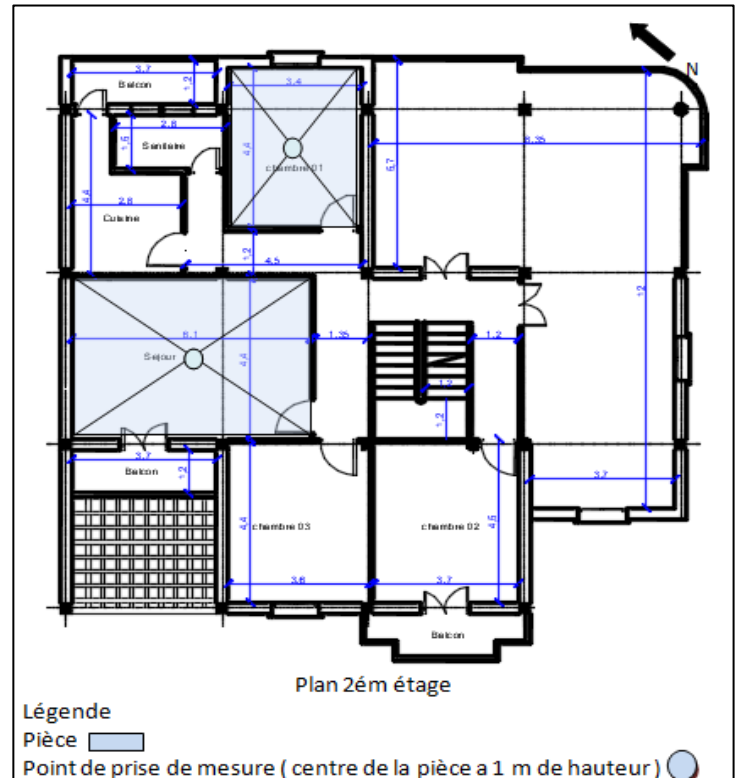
plan 2em étage ech 01 (source : auteur)
